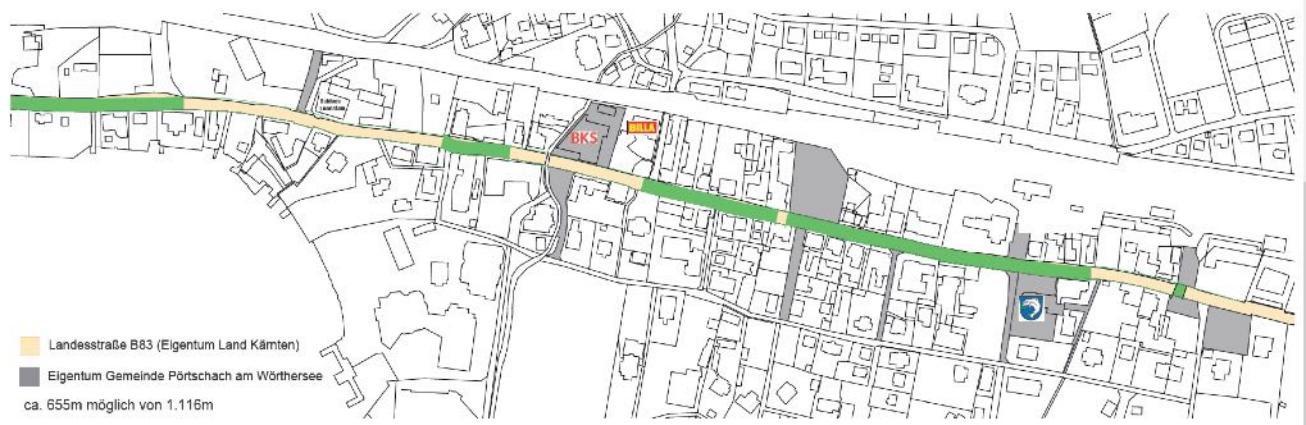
Übersichtsplan Planfall 2, [Quelle: PLANUM]
